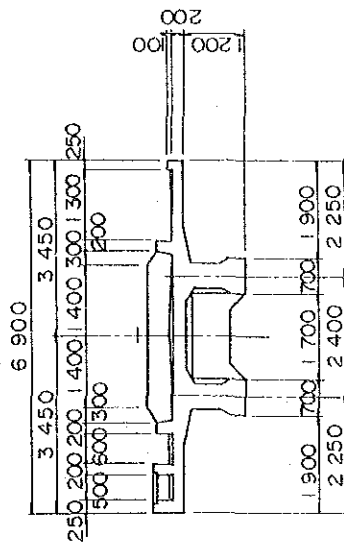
POUTRE DU PONT SUR LA RIVIERE NDJILI
